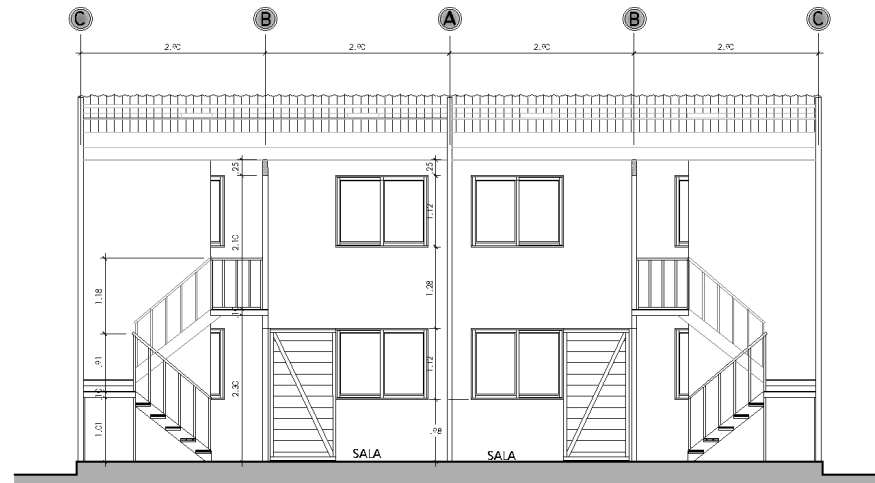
corte transversal D-D' (muros prefabricados-SC), macro-proyecto San Antonio. Fuente: Arq. Jemay Parra. Ocampo.
